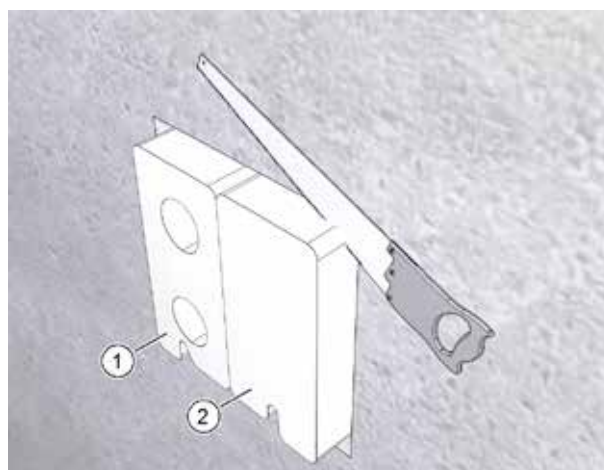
Modifica della cassetta a muro con elemento di riempimento
